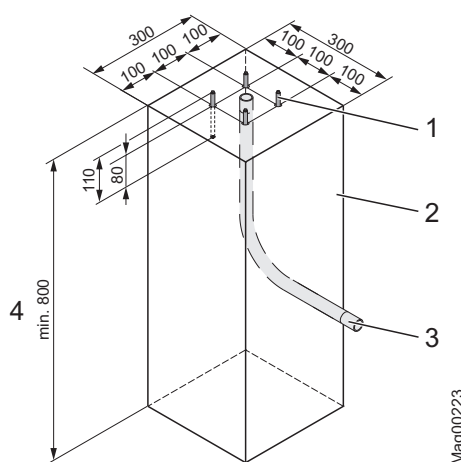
Fundamentschema stöd Stolpe och fotocells stolpe (mått i mm)
